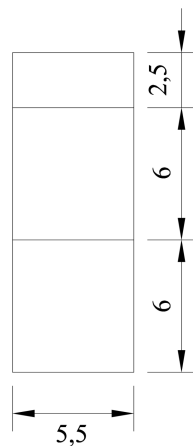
Vista lateral da travessa analisada (Dimensões em cm).
